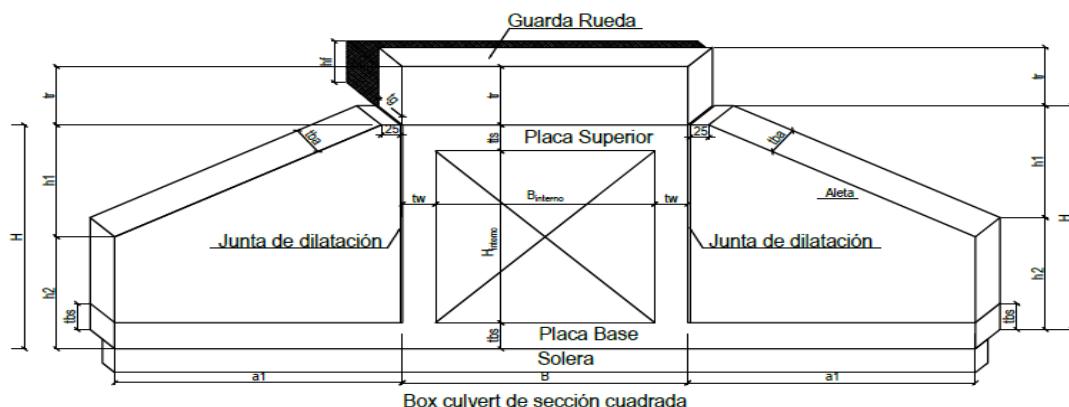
Vista en perfil Sección Aleta Box Culvert
